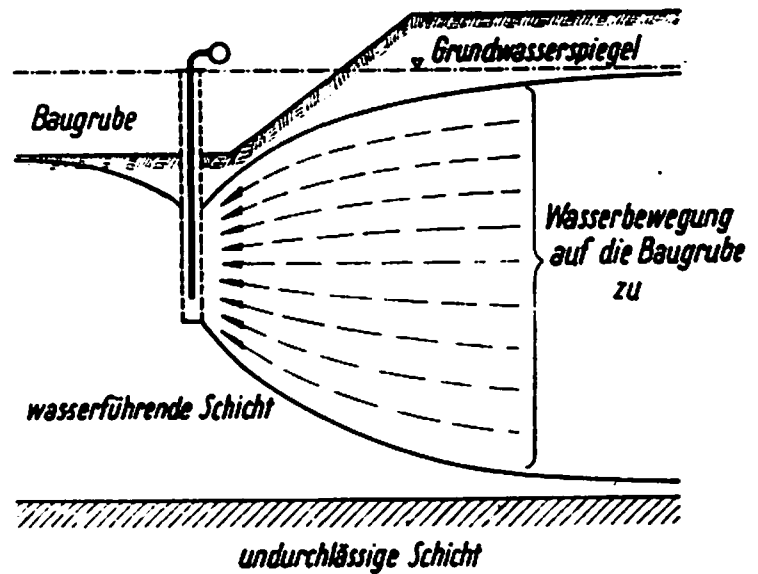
Darstellung der auf die Baugrube zu gerichteten Grundwasserbewegung bei Anwendung unvollkommener Brunnen.
